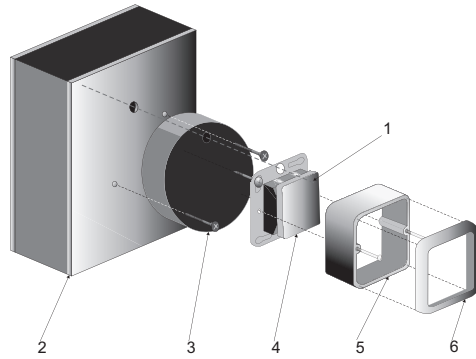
Схема крепления выключателя: 1 — линия прохождения сквозного отверстия; 2 — стена гаража; 3 — подрозетник; 4 — механическая часть выключателя; 5 — корпус; 6 — заглушка
